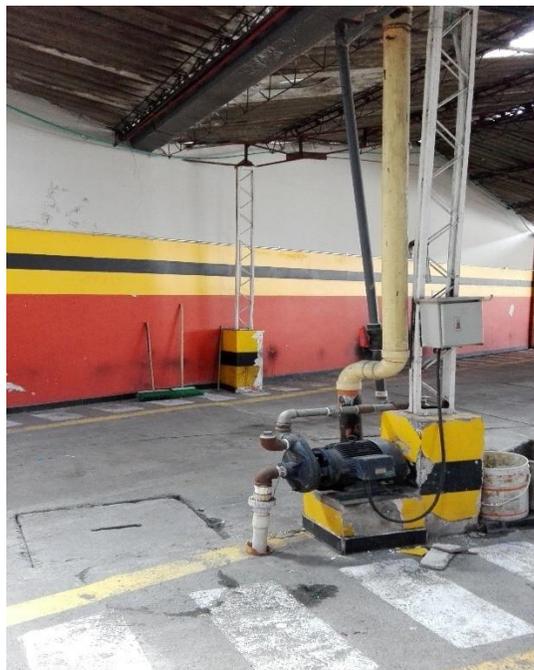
Pozo 1, Ubicado detrás de la Biblioteca
